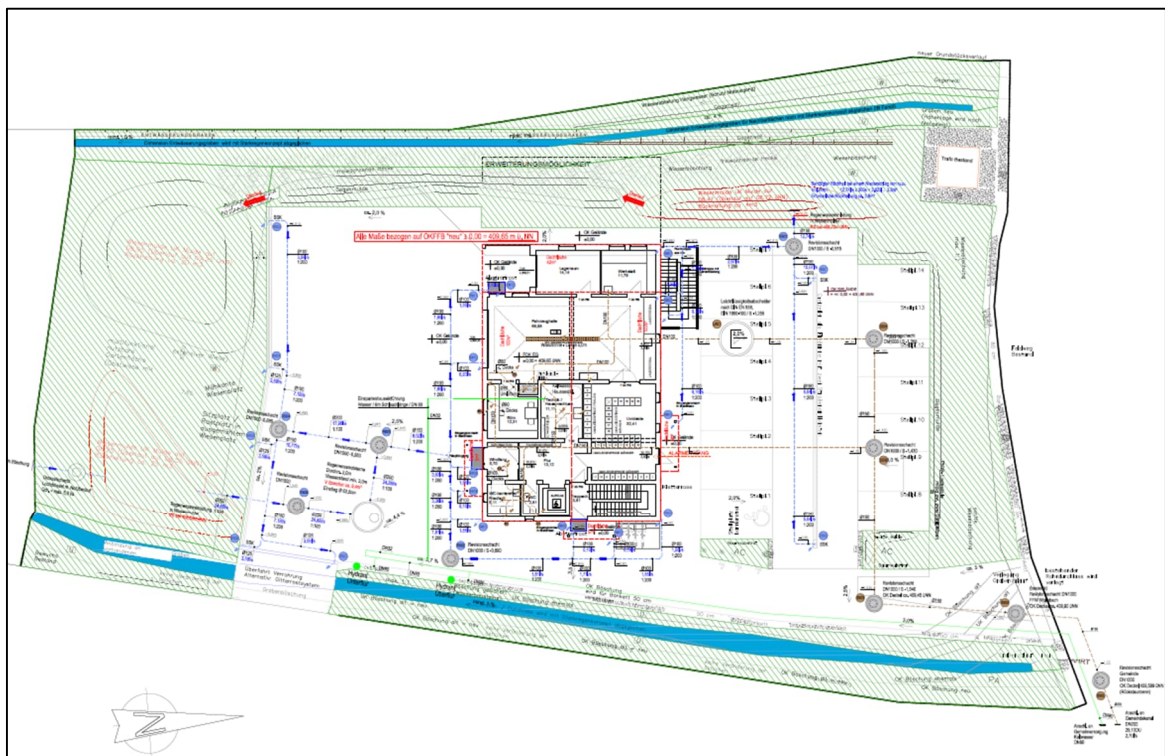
Ausschnitt Entwässerungseingabeplan, Planungsbüro Schmid
